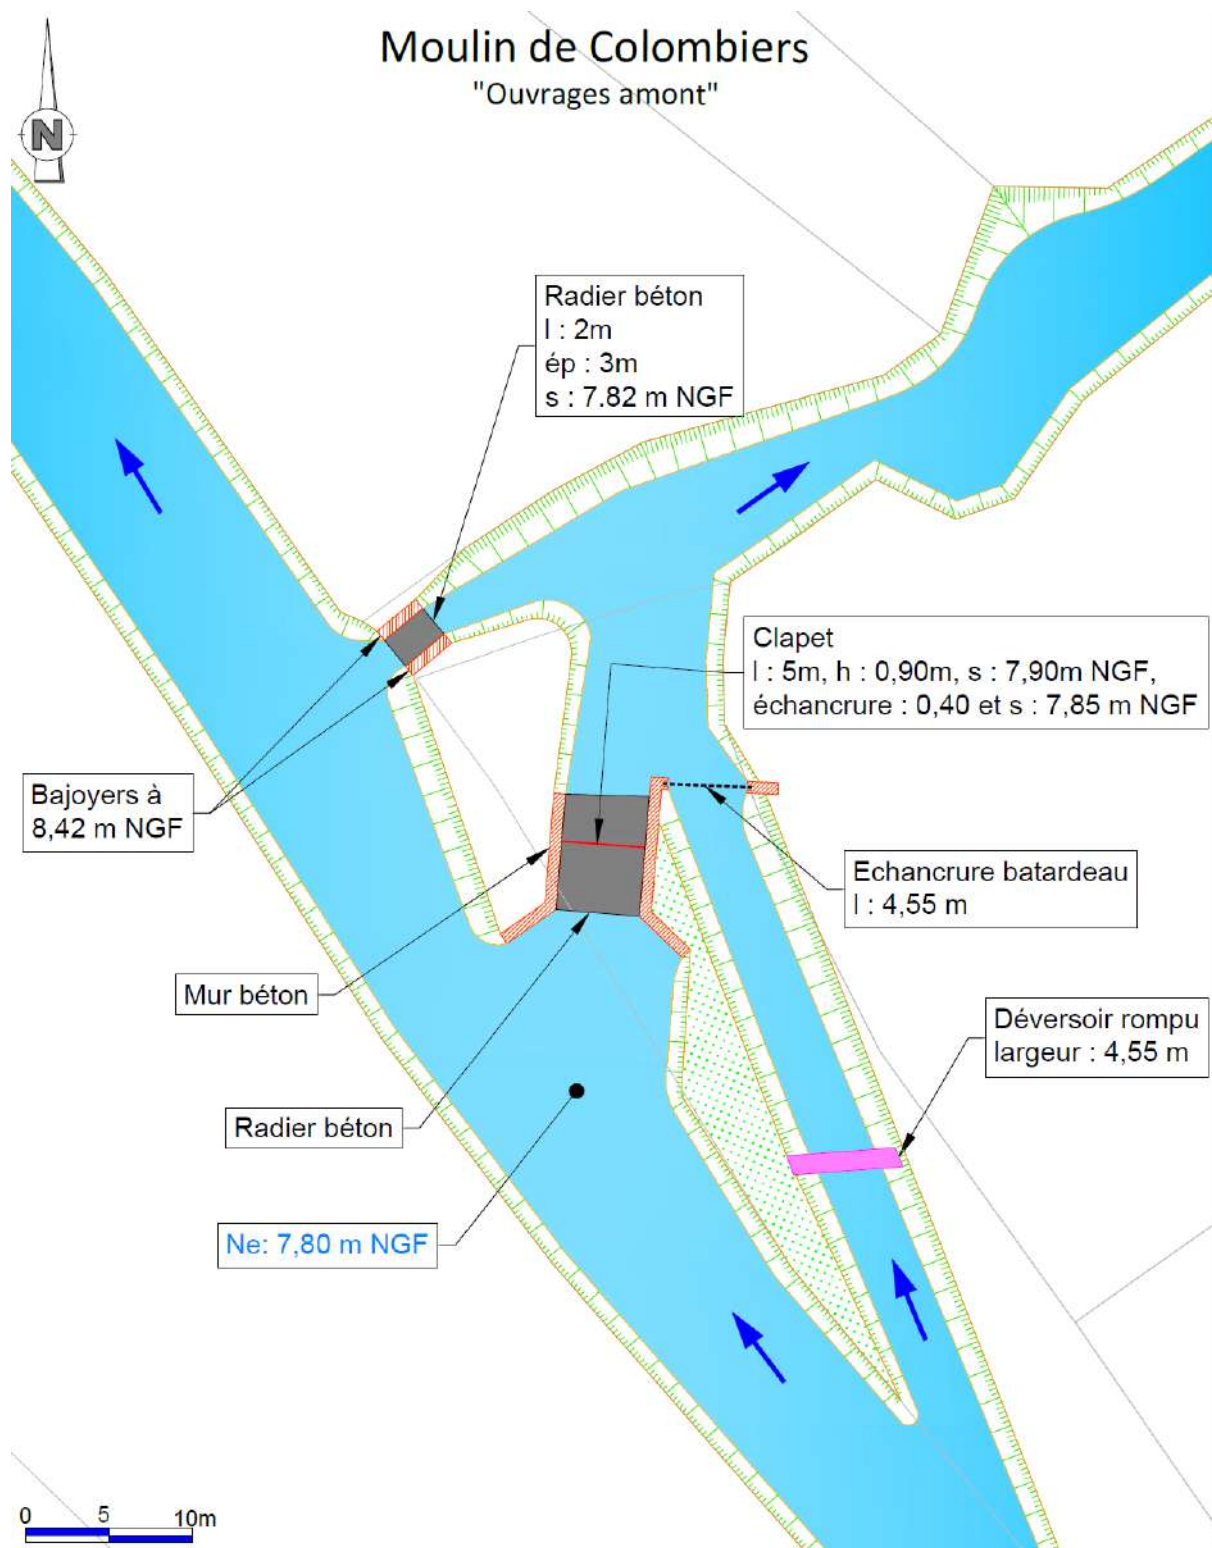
Vue en plan des ouvrages de prise d'eau du moulin de Colombiers
